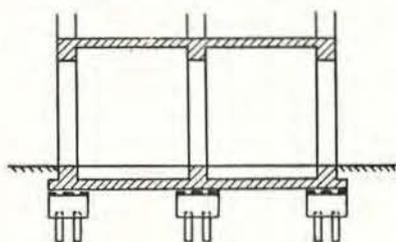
Séparation de la fondation sur pilotis et de la base du bâtiment par un joint de glissement.
